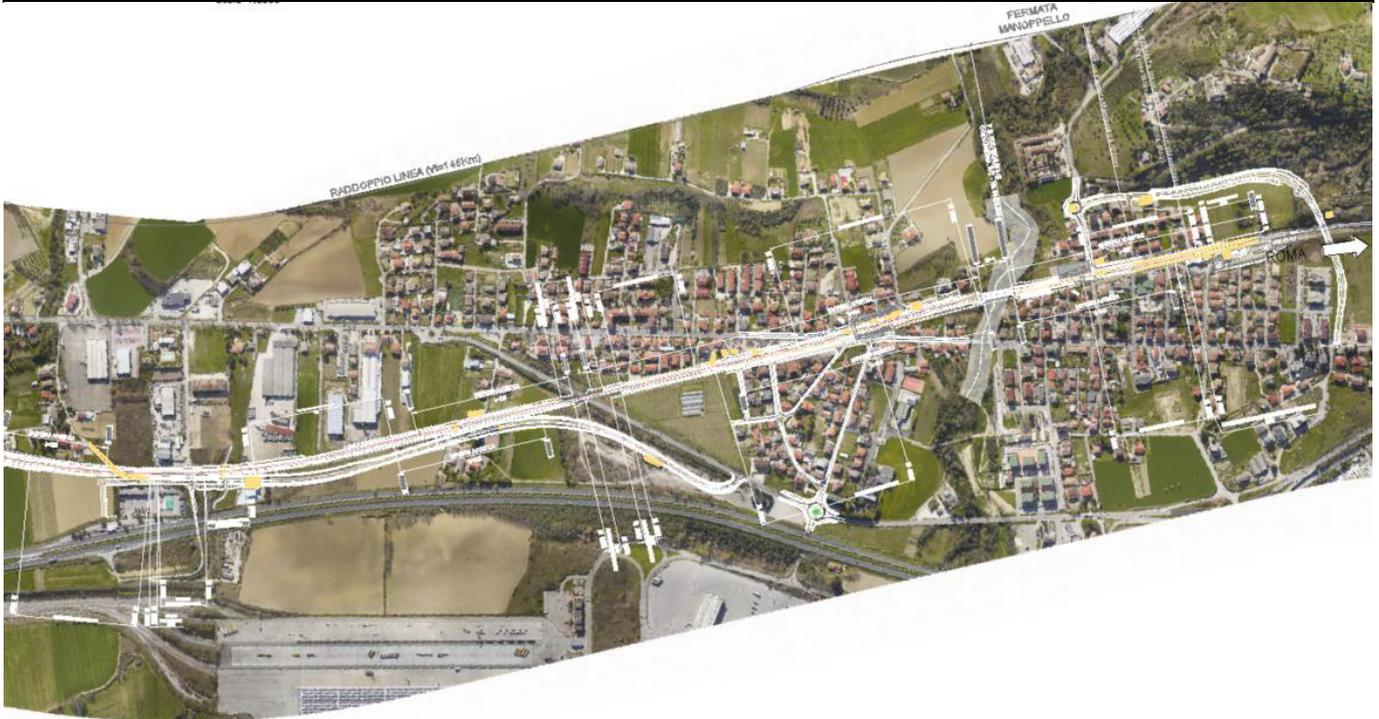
Inquadramento planimetrico su ortofoto dal km 3+000,000 a fine intervento
